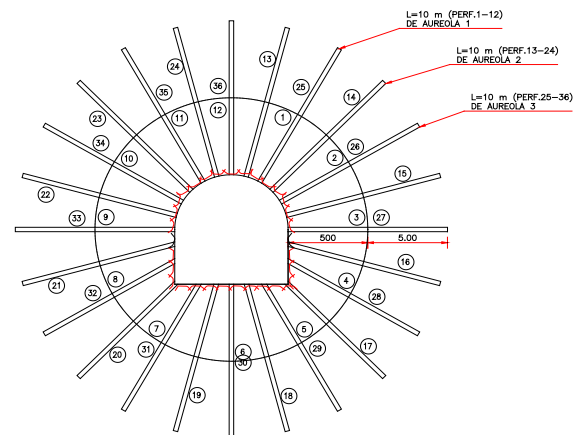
Distribución de Inyecciones de Impermeabilización
